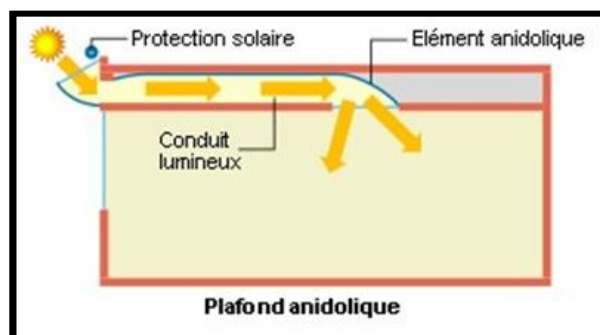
Impact d'un plafond anidolique sur la pénétration solaire
